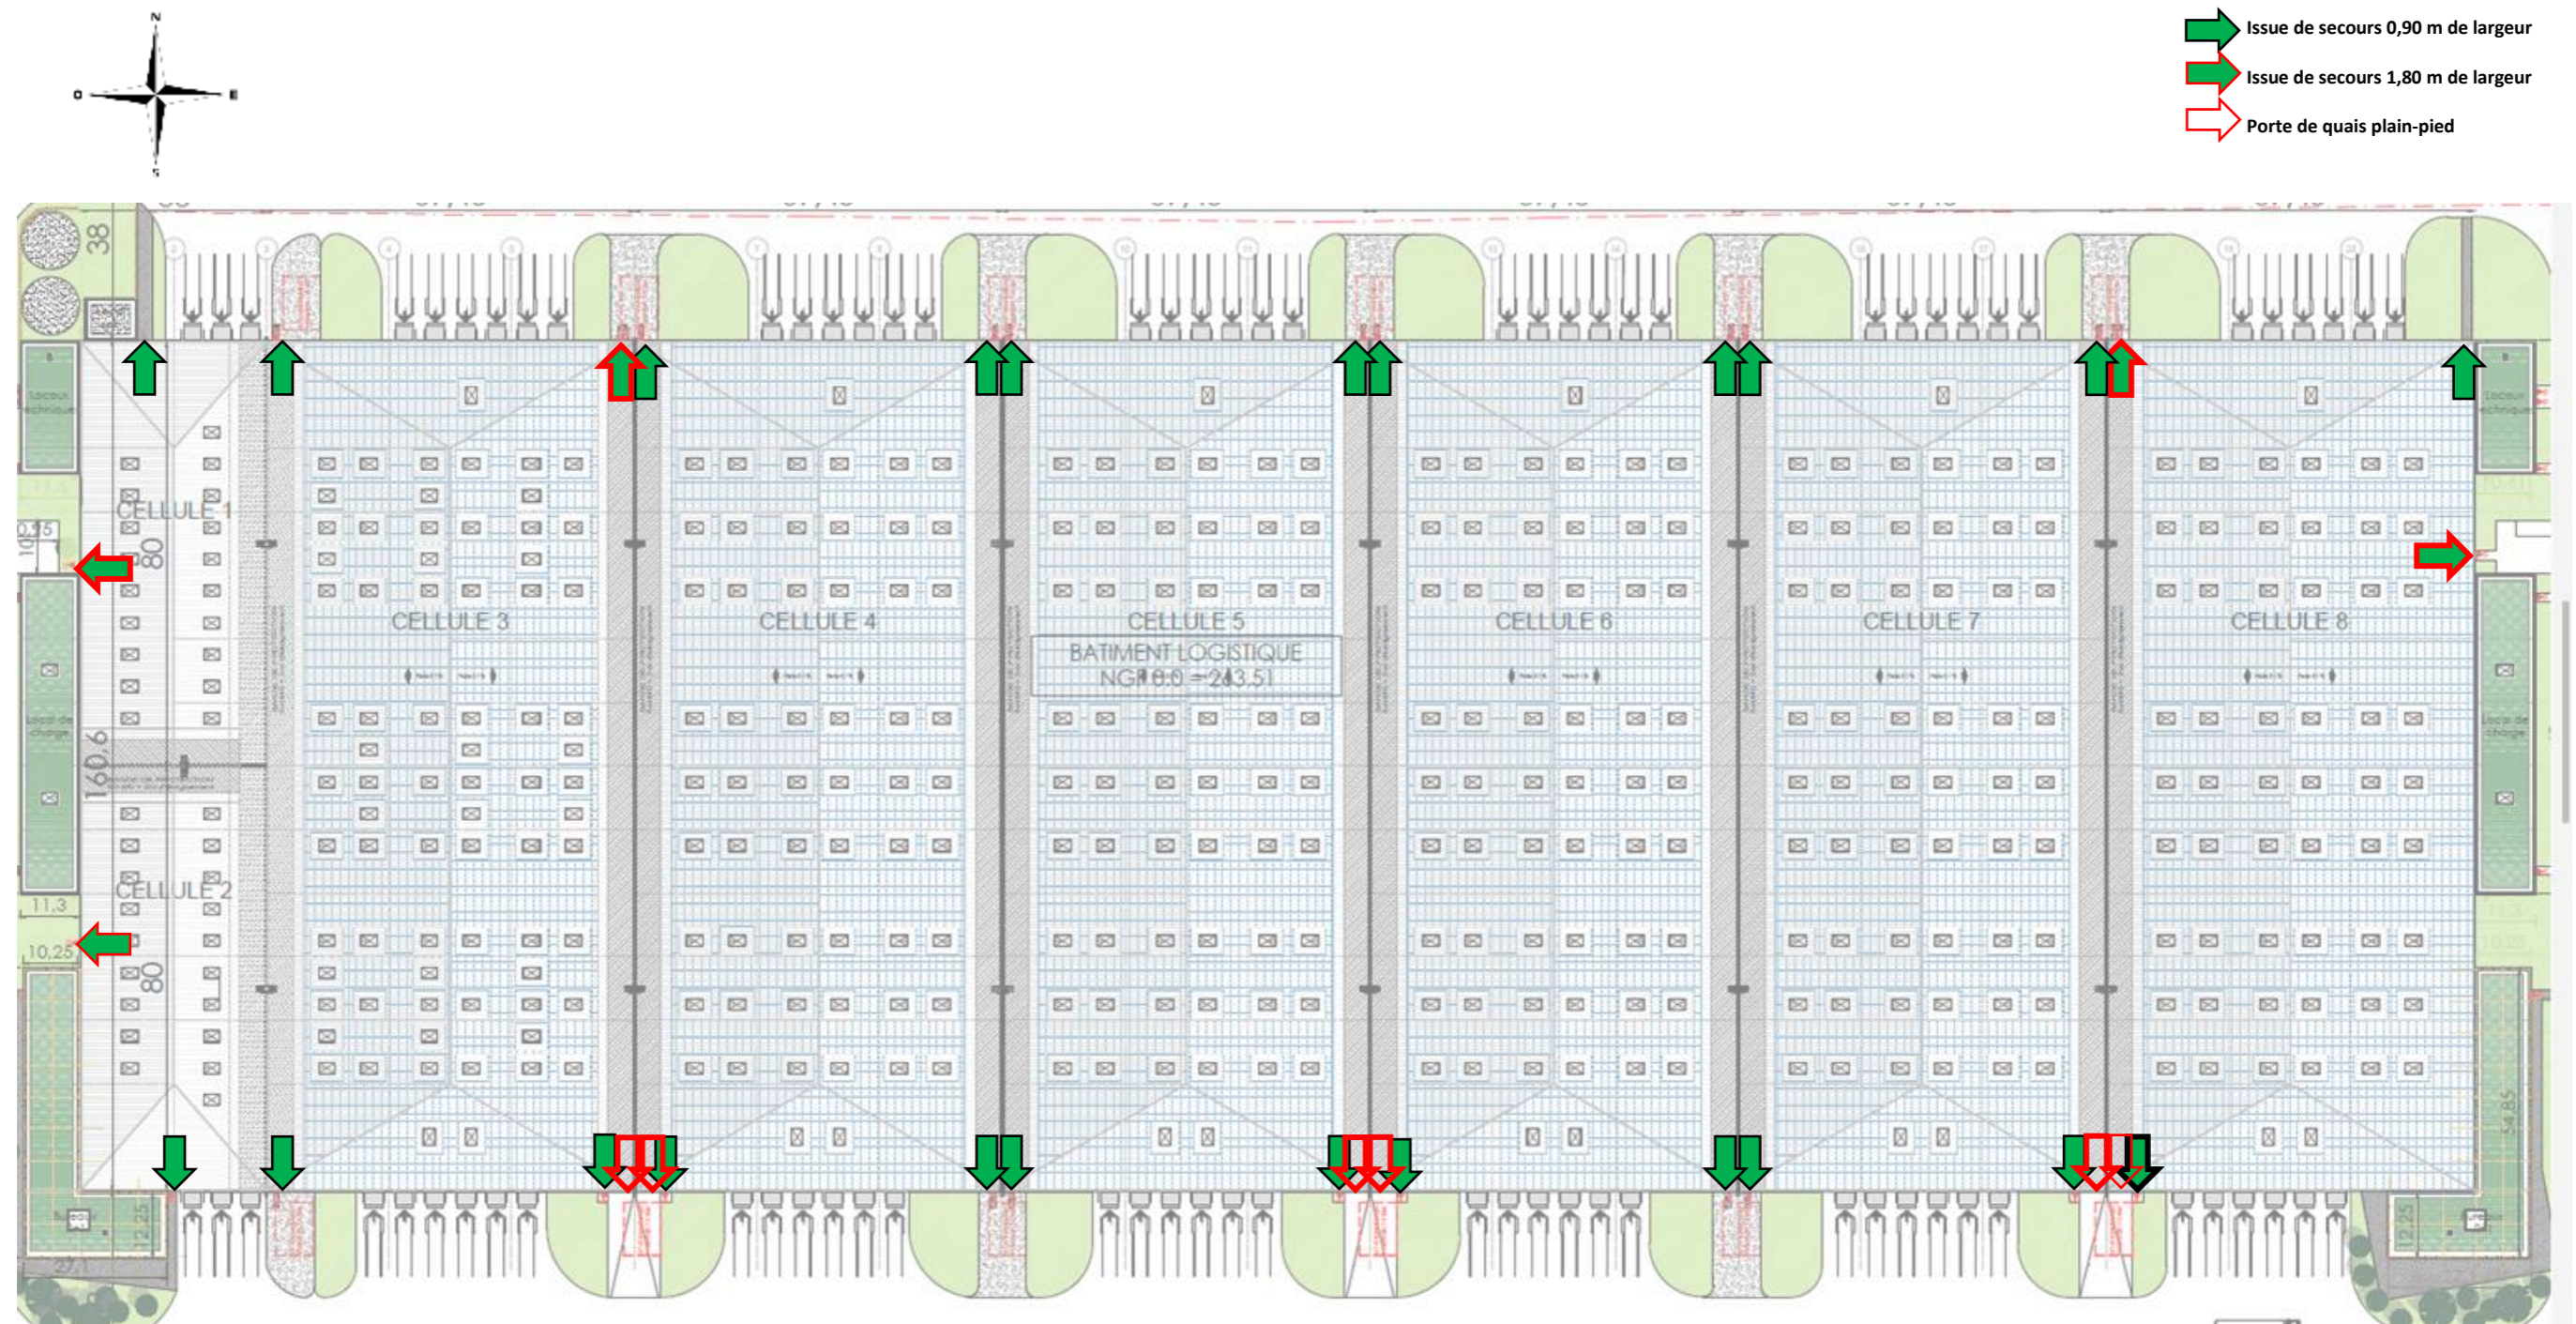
Plan masse permettant de visualiser les issues de secours de l'entrepôt
